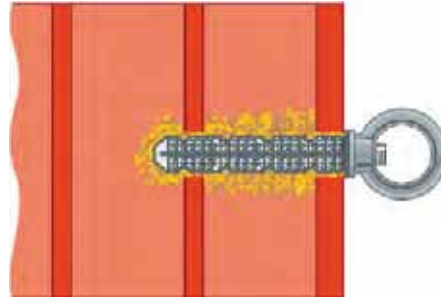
Öse zur Befestigung eines Fassadengerüsts, montiert mit einem Injektionsdübel in einem Lochstein
